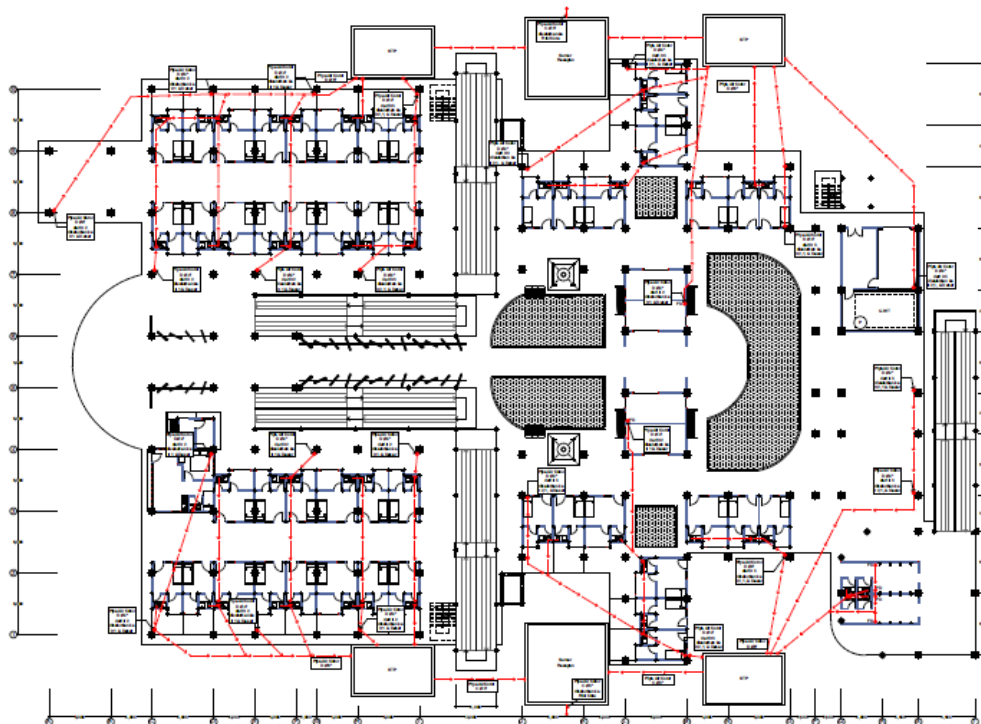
Rencana Kolom Balok Lantai Dasar
